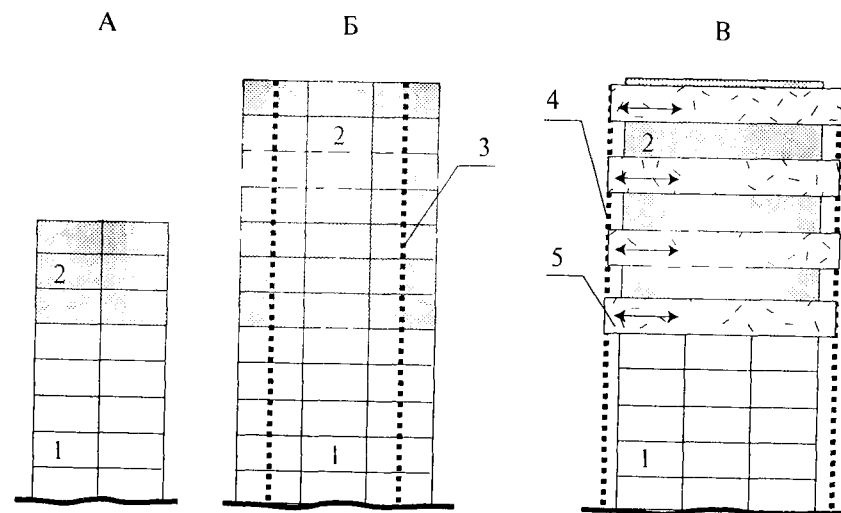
Конструктивные схемы многоэтажных надстроек
